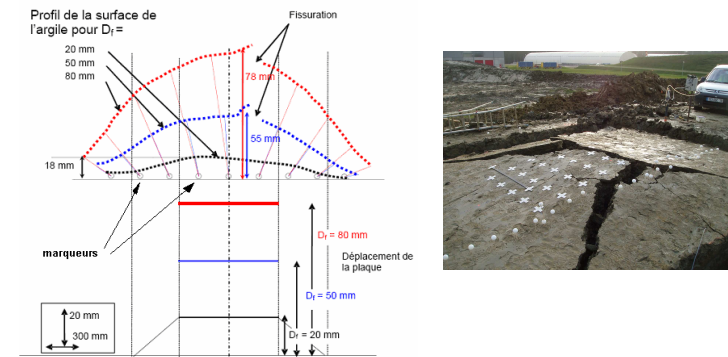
Evolution du profil vertical de la planche d'essai T3 d'après Camp (2008).
